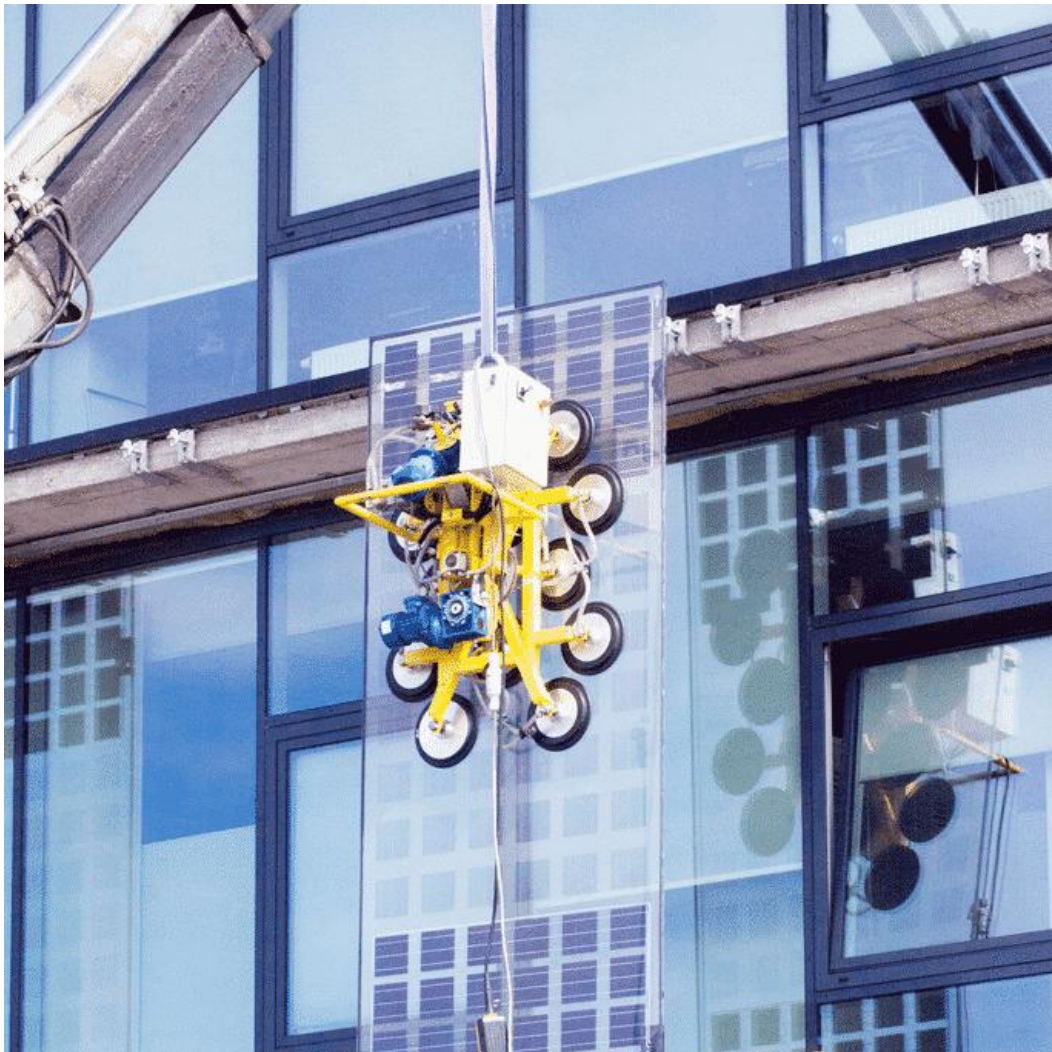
Instalación de fachada ventilada, fuente: Metsolar
